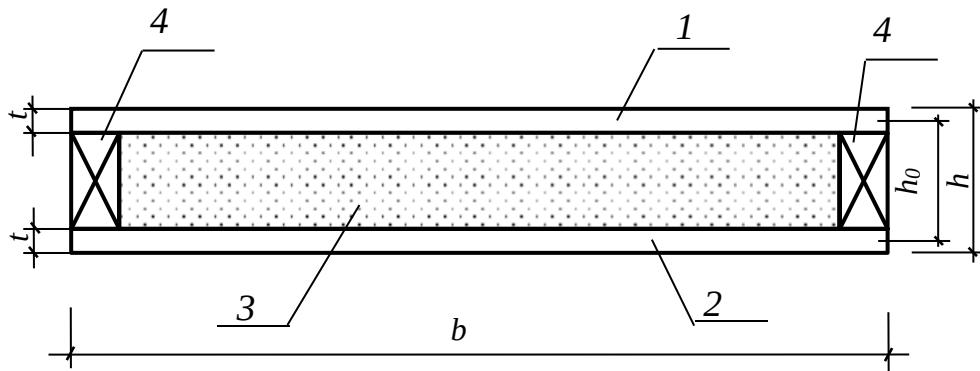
сечение трехслойной плиты покрытия с асбестоцементными обшивками: 1 – верхняя обшивка; 2 – нижняя обшивка; 3 – средний слой (пенопласт); 4 – обрамляющие бруски
